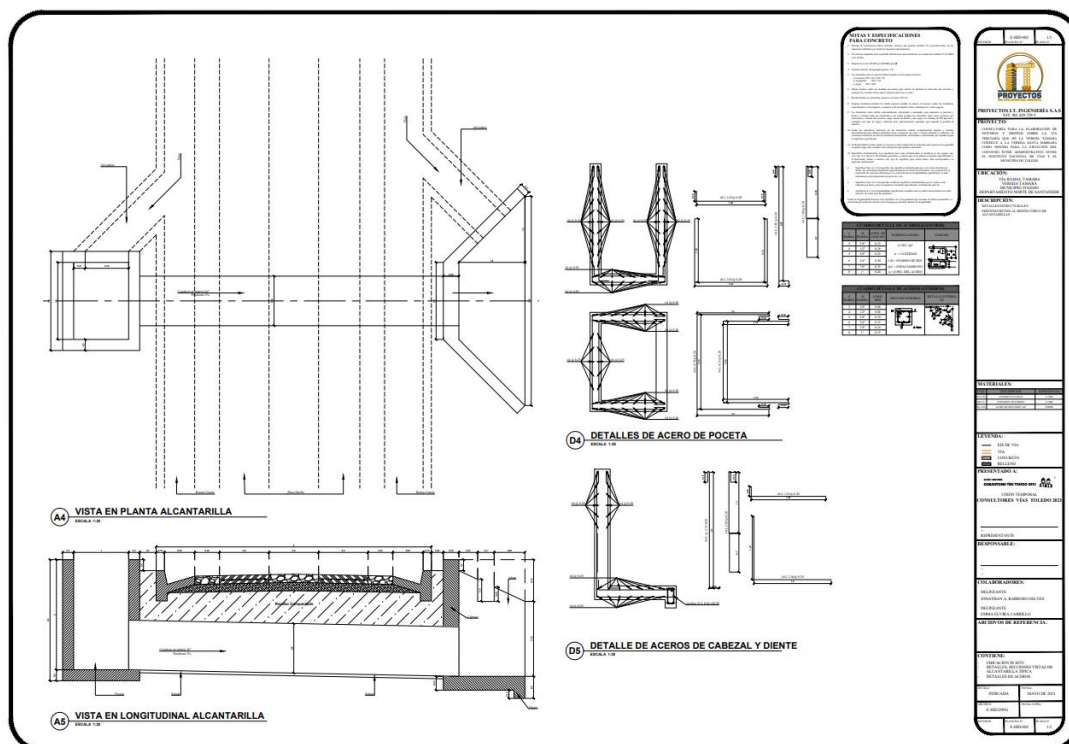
Detalle estructurales obras hidráulicas fuente (propia).
